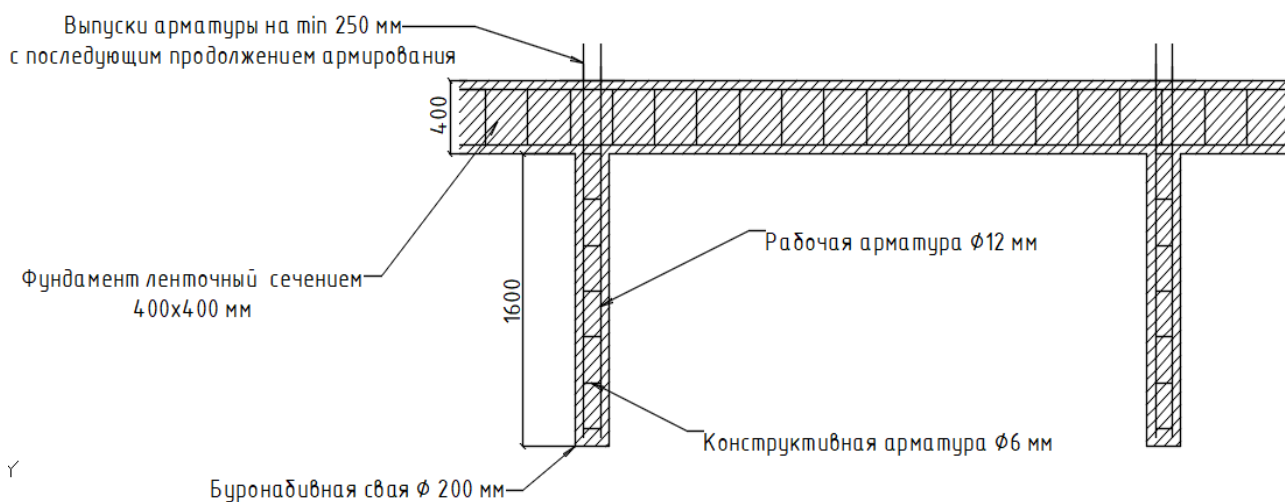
Схема армирования фундамента с применением буронабивных свай объединенных монолитным ростверком
